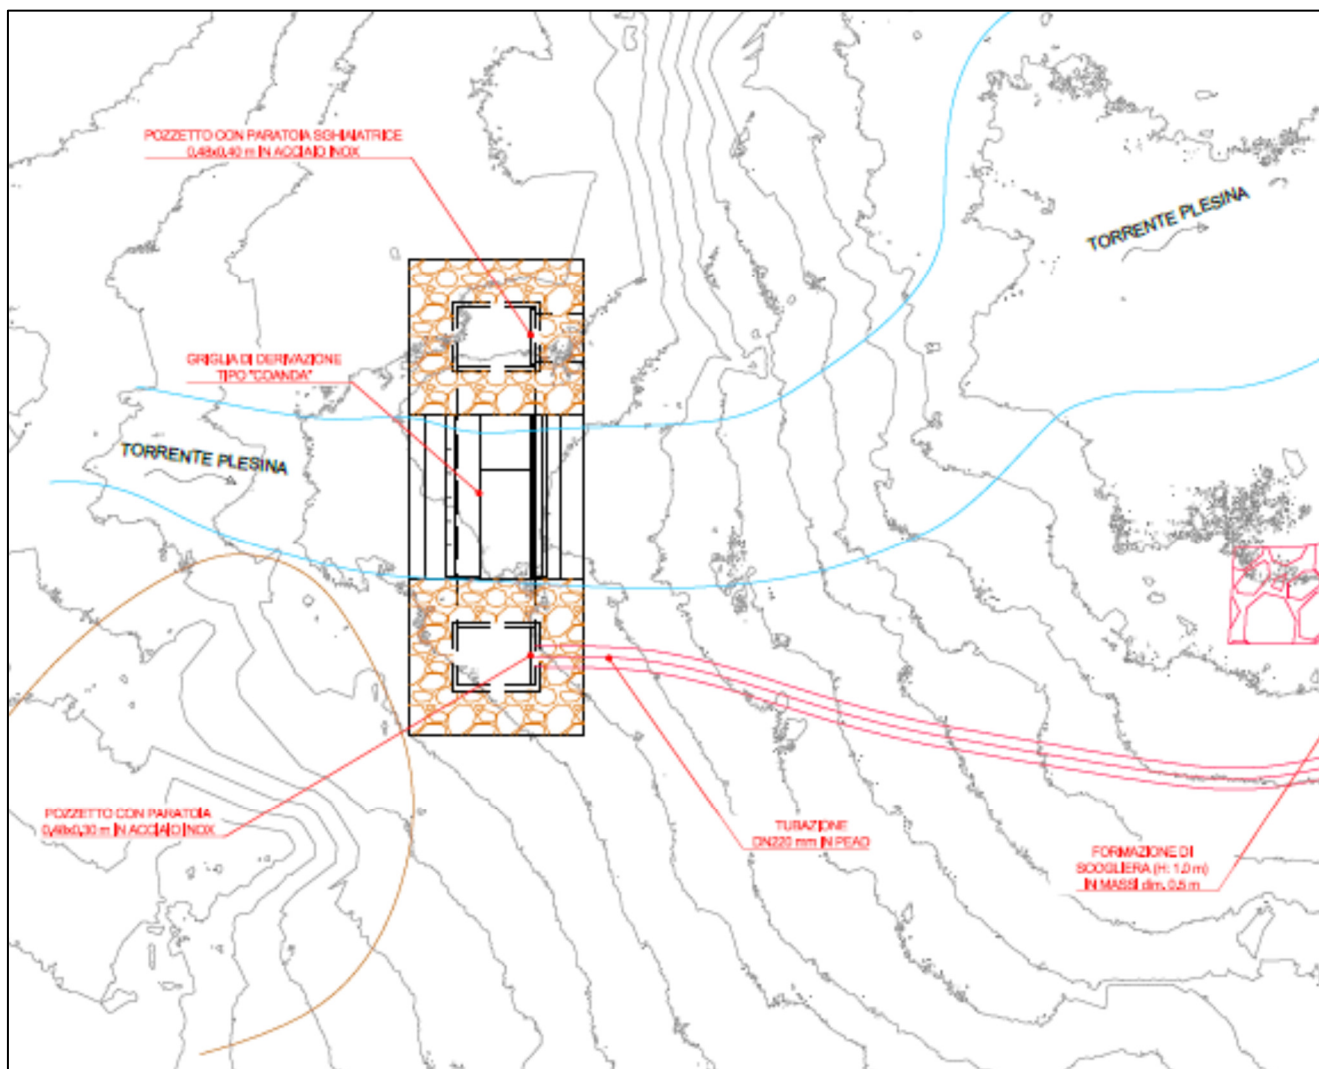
Planimetria di dettaglio dell'intervento in previsione (rio Plesina)
